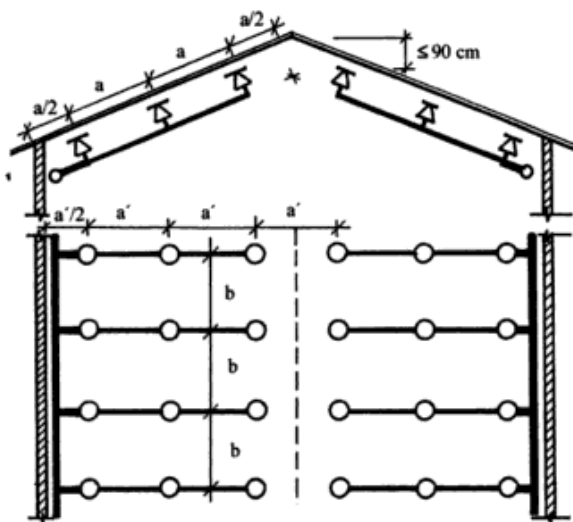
Posicionamento de sprinklers no tecto inclinado
